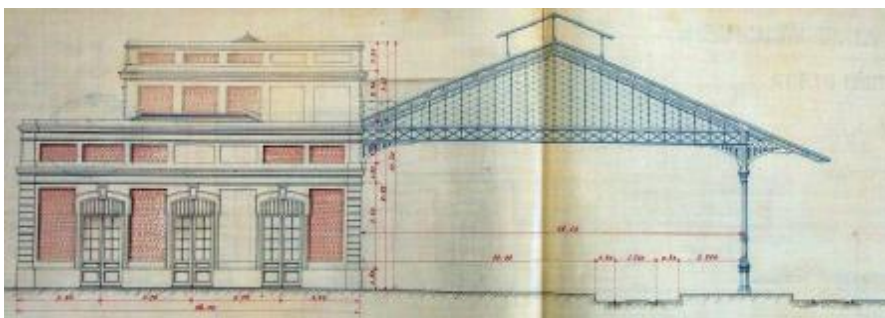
Alzado testero con cubierta metálica. E. San Sebastián. (FFE) (2011).
